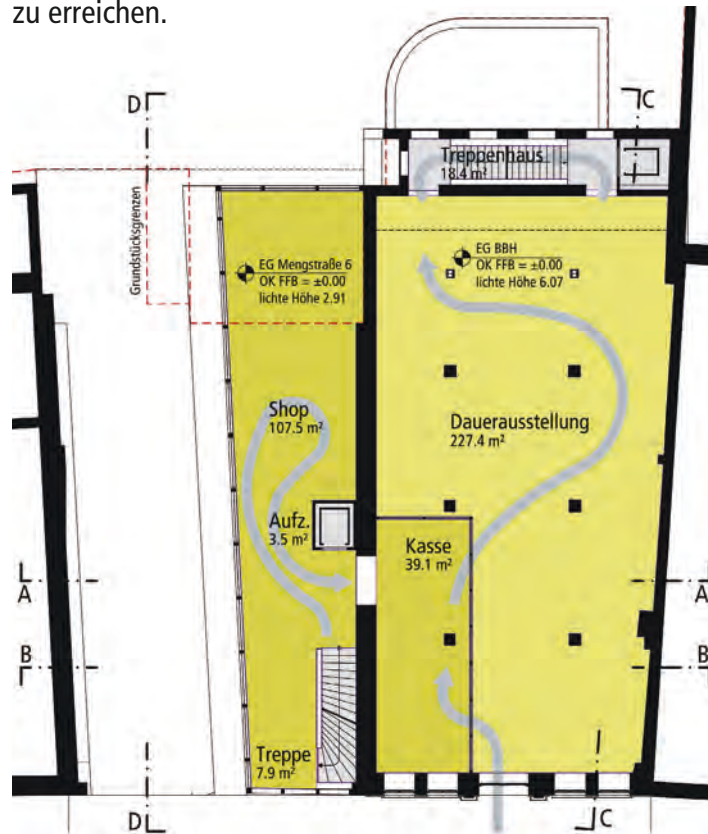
Variante 1, Grundriss Erdgeschoss
